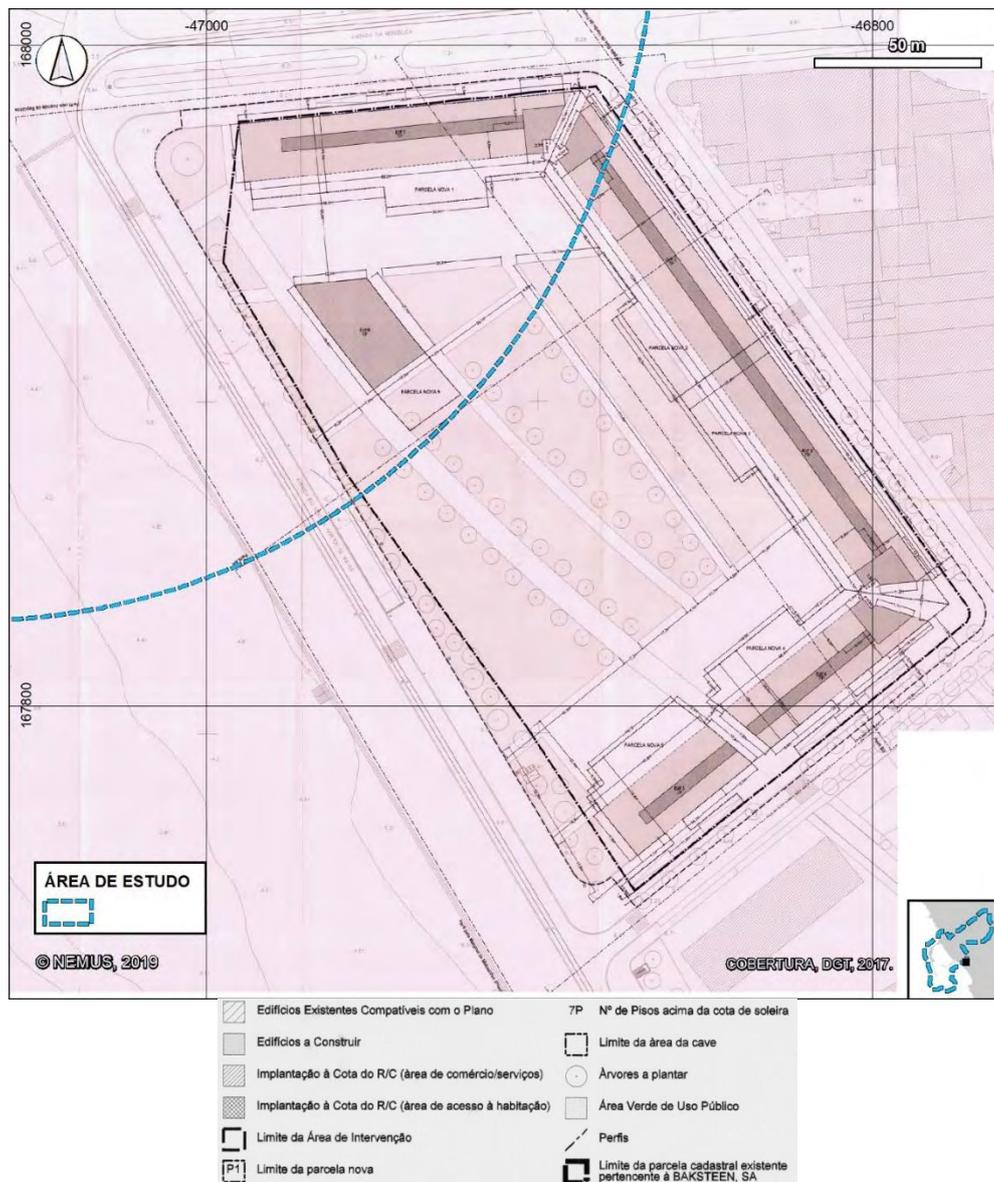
Extrato de Planta de Implantação do PP da Gist-Brocades
